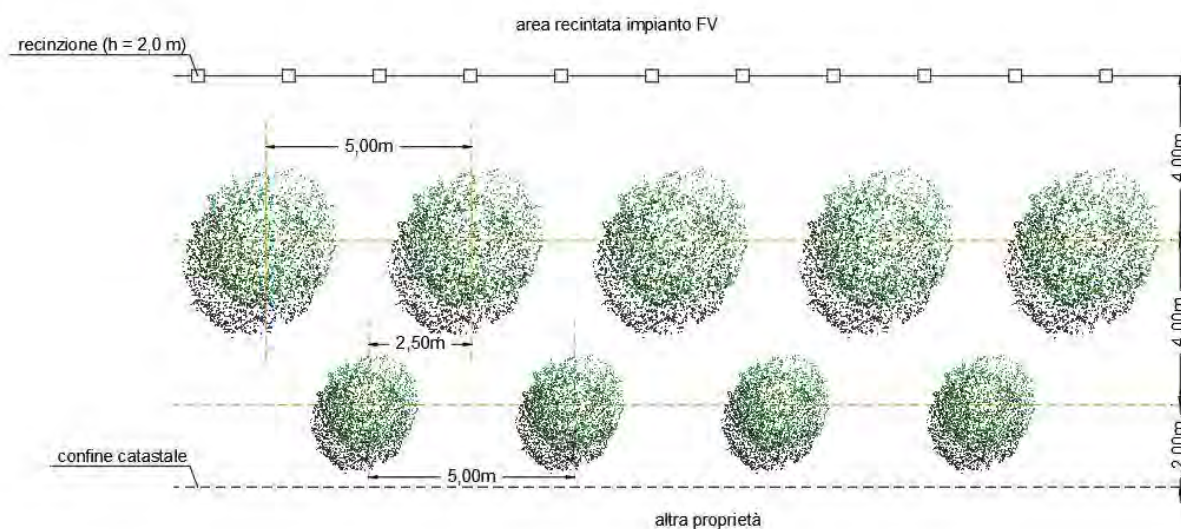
Siepe polispecifica (planimetria di progetto).
